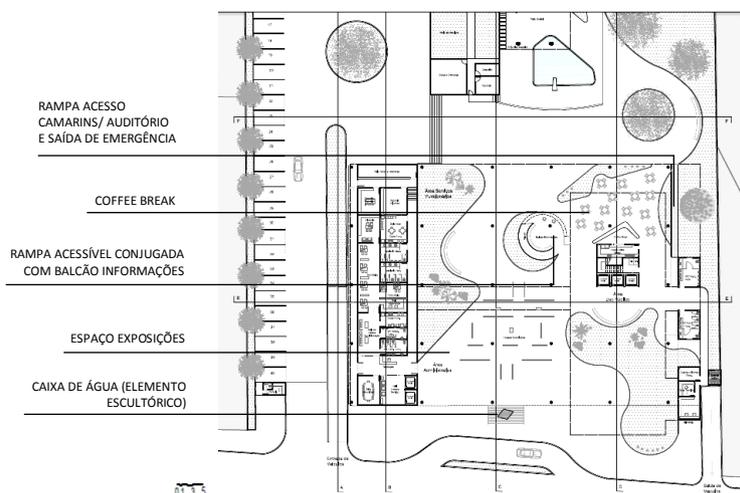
Planta Piso 0 Centro Cultural Borsoi (Ver em Desenhos Técnicos planta piso 0).
